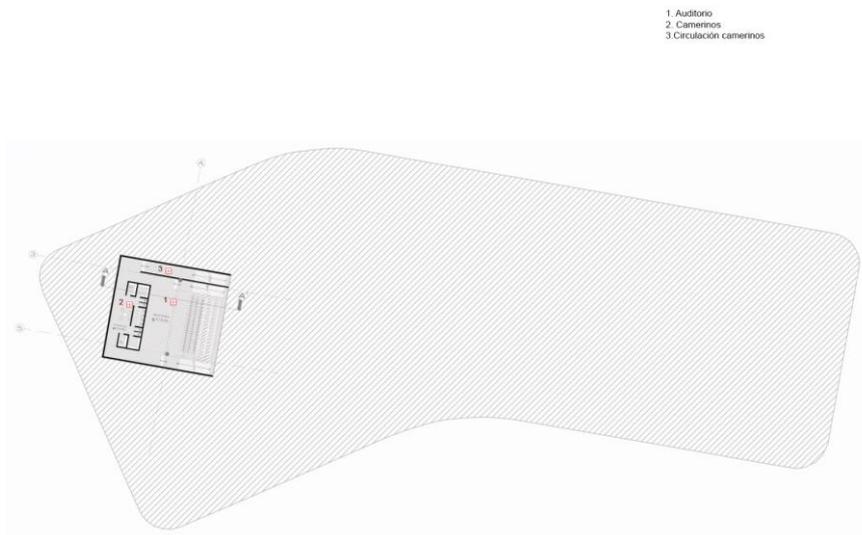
Planta Subsuelo 3 (Elaboración propia)
